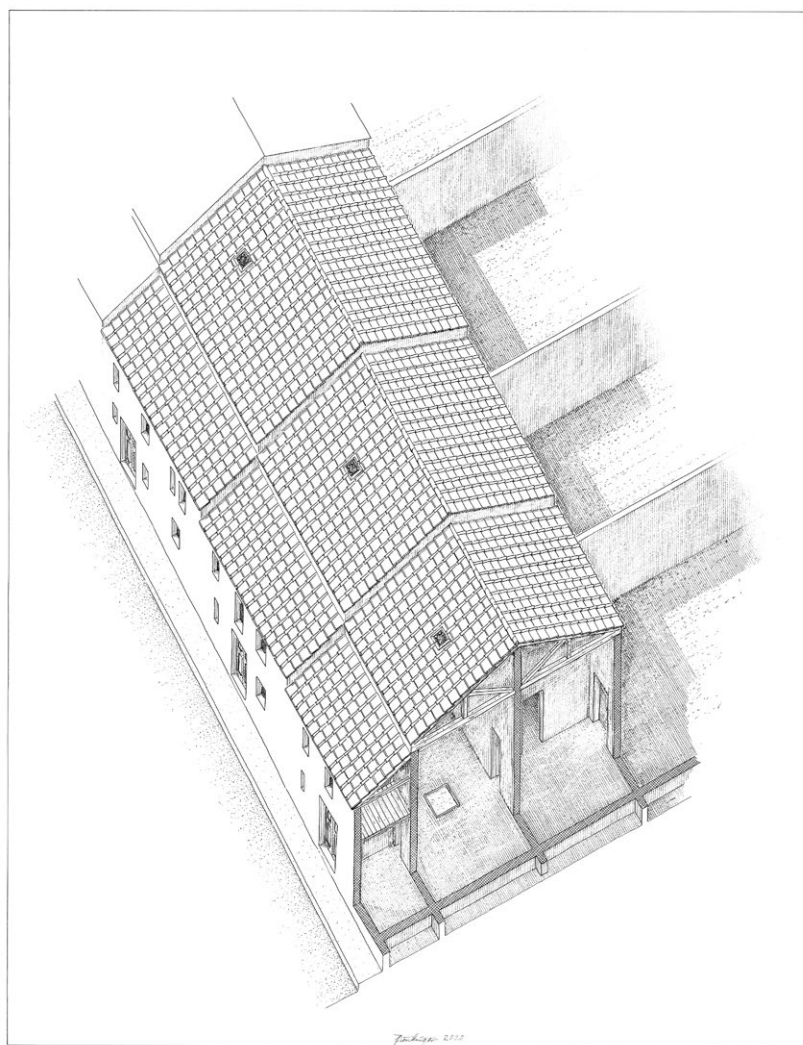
Pompei. Prima proposta di ricostruzione assonometrica delle case I 11, 12-14
